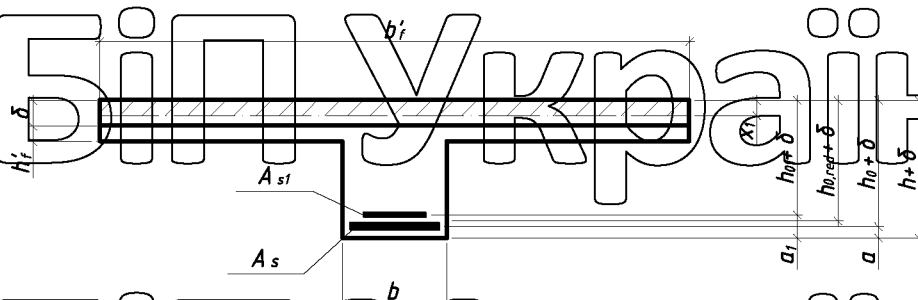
Розрахунковий переріз плити з підсиленням.
